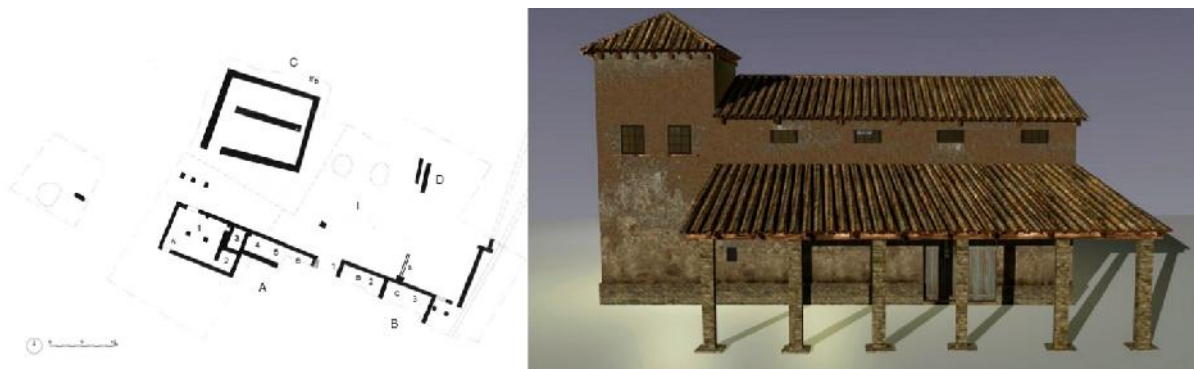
Roncade-Ca' Tron-sito A (TV-01). Planimetria del complesso e ipotesi ricostruttiva del magazzino/granaio (planimetria rielaborata da BUSANA et alii 2012a; ricostruzione di CARPANESE 2012).
